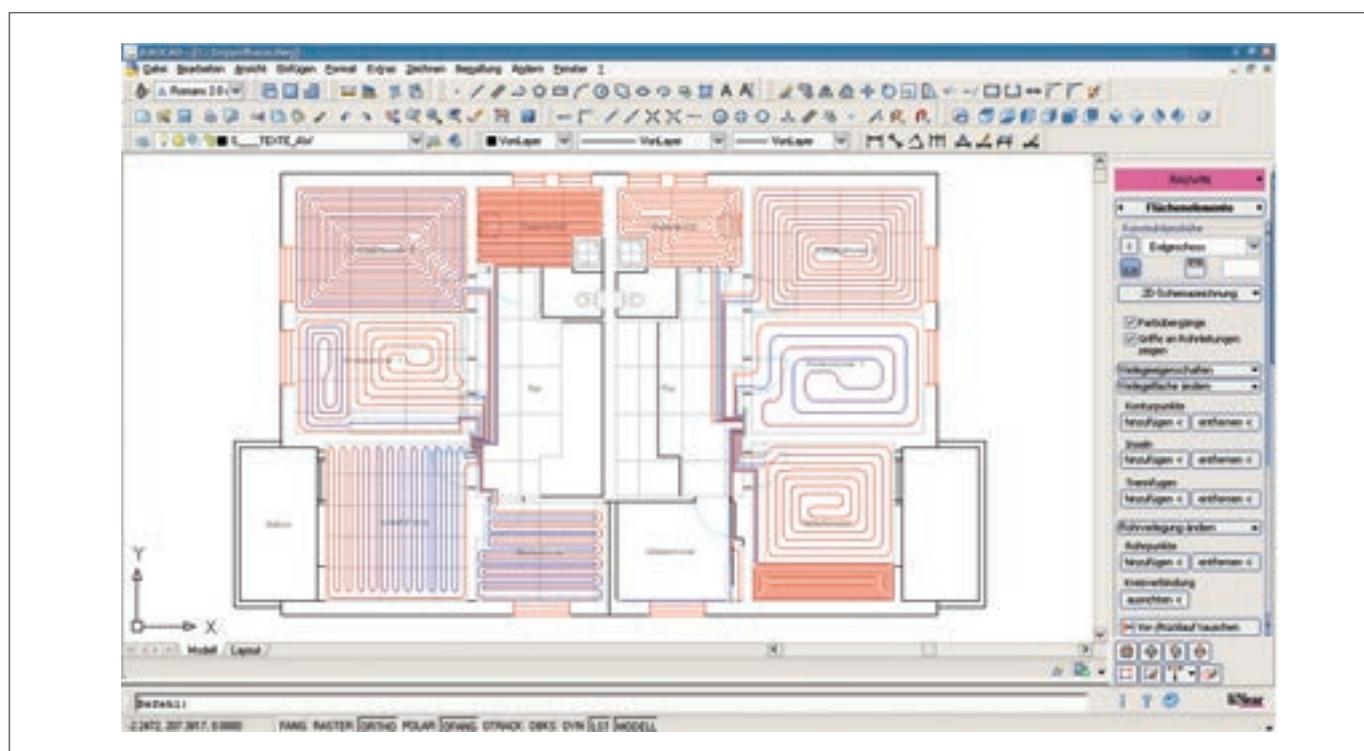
Esempio di progettazione di un sistema di riscaldamento a pavimento con il software di progettazione RAUCAD
